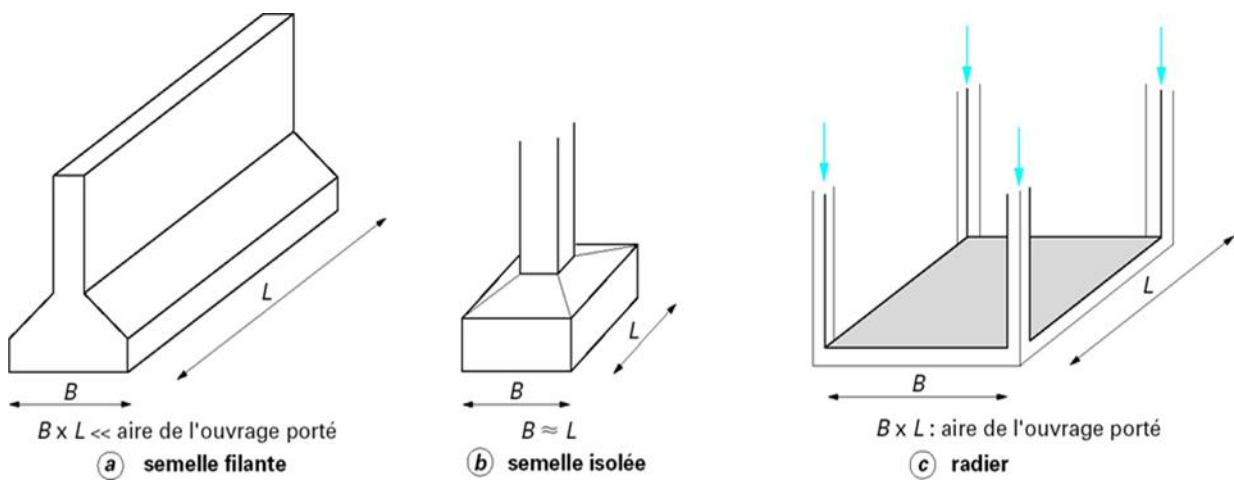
Type des fondations superficielles (Frank, R (1998))
